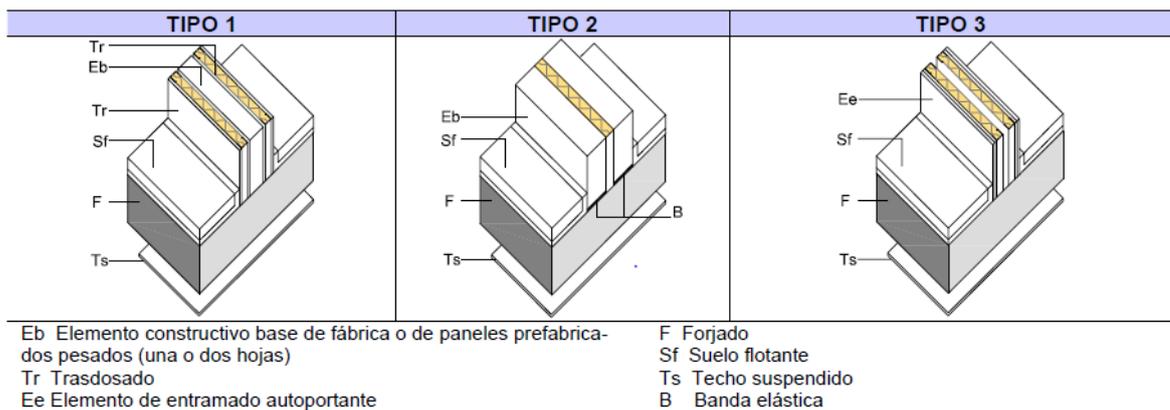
Tipos de elementos de separación vertical apoyado sobre forjado (Fuente: [15])
